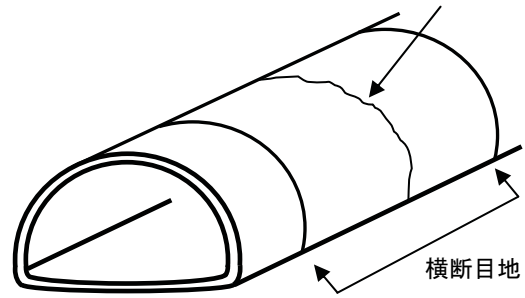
温度応力・乾燥収縮による横断方向のひび割れ
